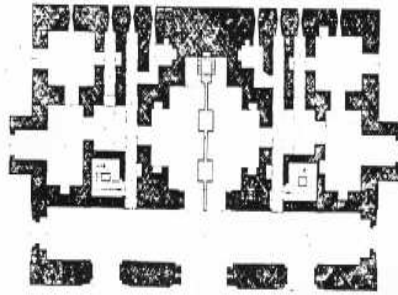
مسقط أفقي لكنيسة القديس جيوفاني ببالرمو (القرن ١٢) من :
